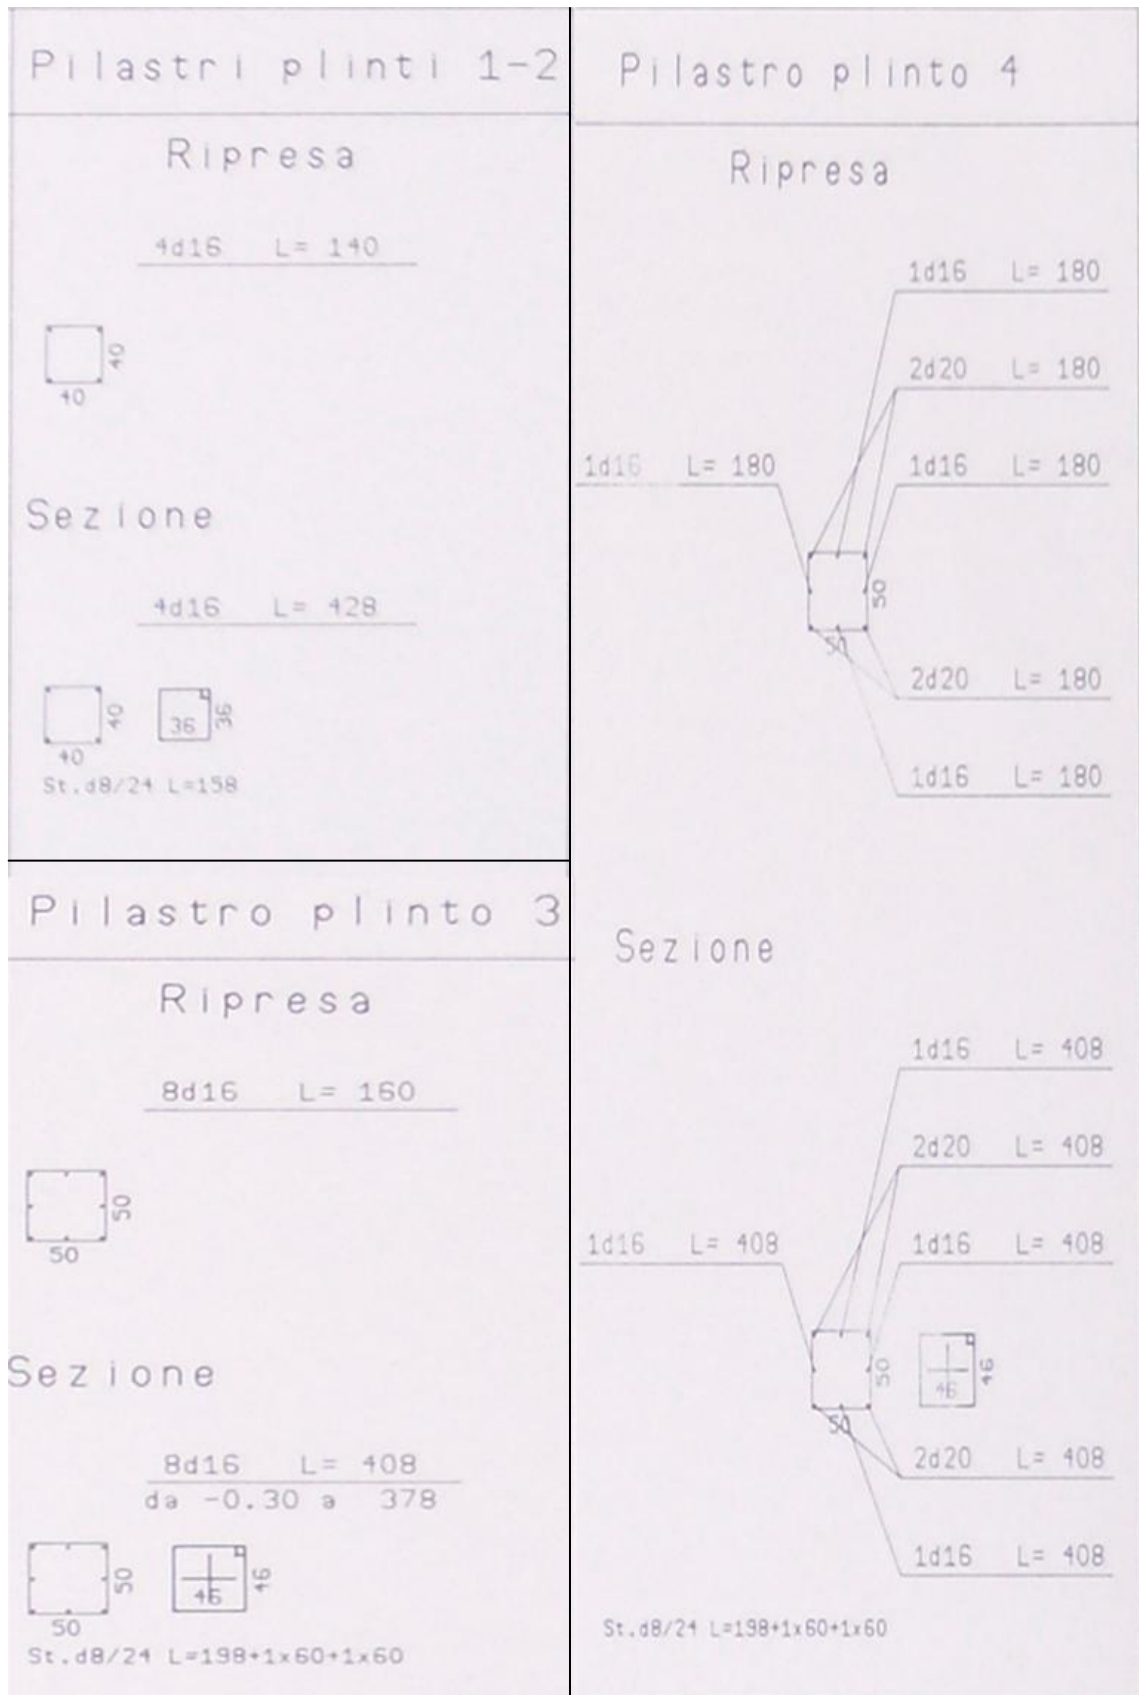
Particolare di A.1996.cap.sa.T02 - Strutture di fondazione e pilastri eseguiti in opera - Tipologie pilastri
